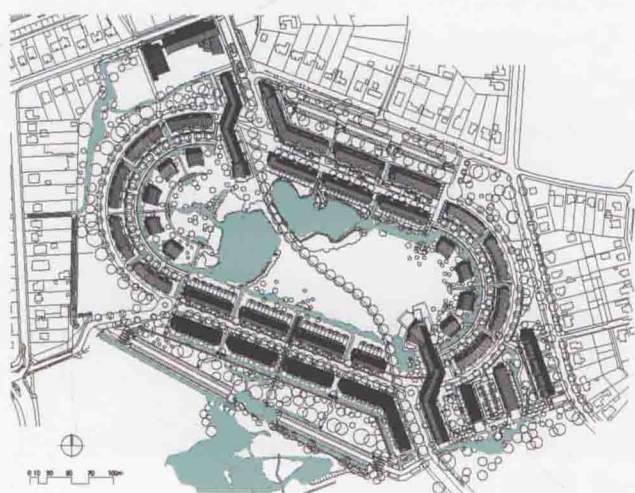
德国汉堡市法姆森马场居住区总平面图
